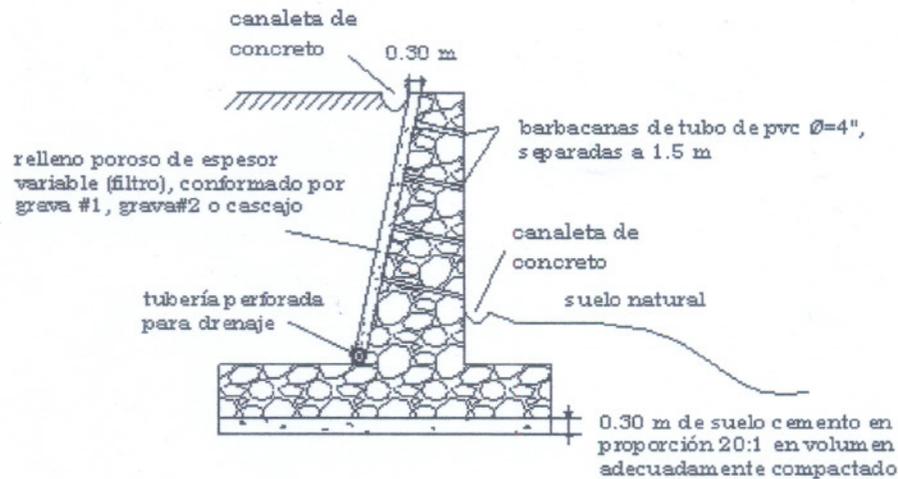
Sección transversal sugerida para muros de retención, mostrando la colocación de sistemas de drenaje transversal.
